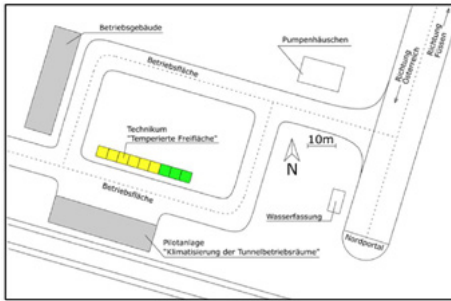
Nördl. Portal Grenzunnel Füssen mit Pilotanlagen „Klimatisierung Tunnelbetriebsräume“ und TECHNIKUM „Temperierte Freifläche“ mit Fahrbahnaufbau aus Asphalt (gelb) und aus Beton (grün)
